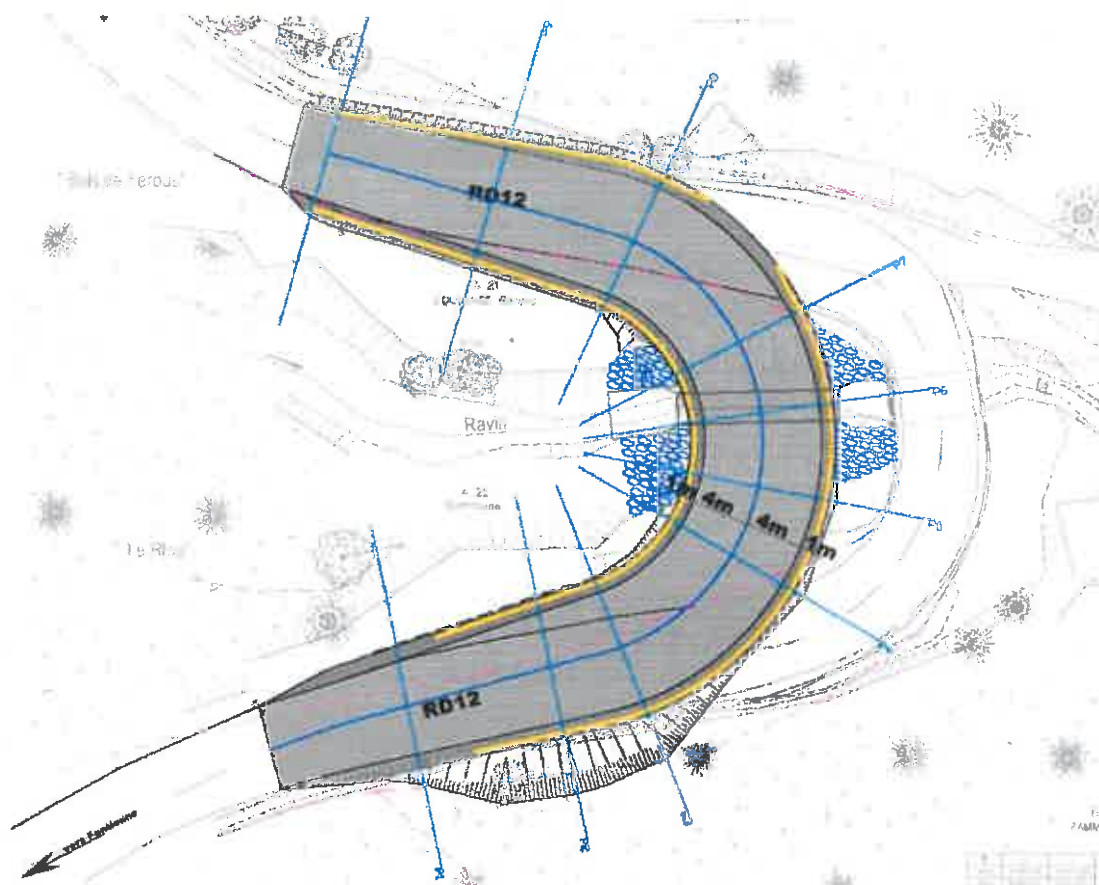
Plan du projet par rapport à l'ouvrage actuel (reconstruction du pont - SCE, juillet 2013)
